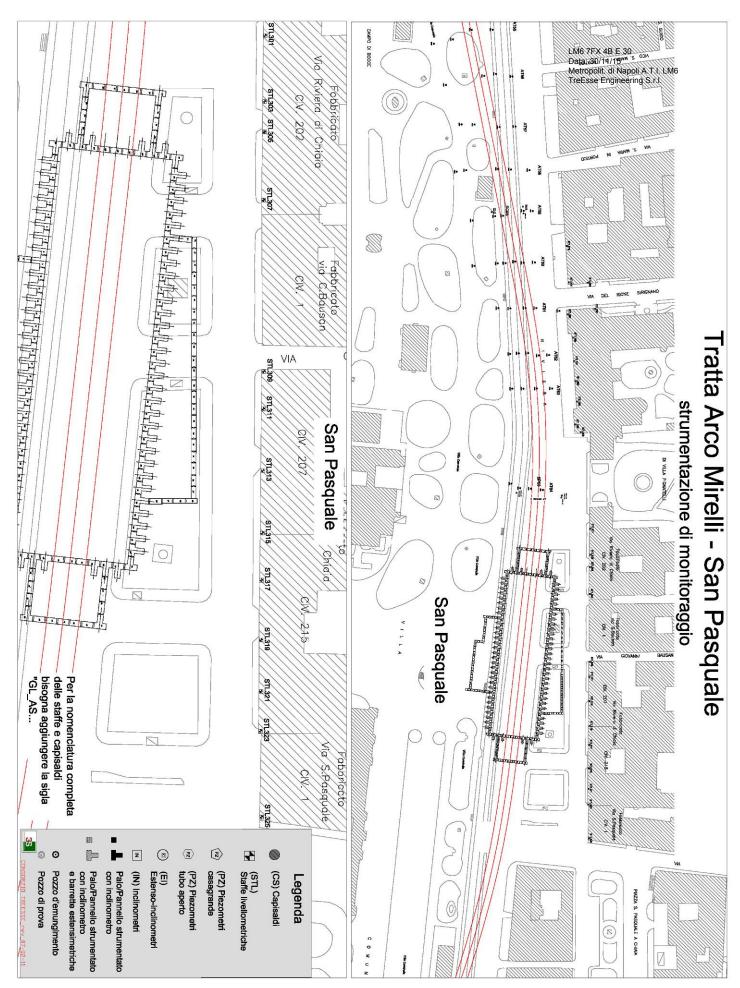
Planimetria tratta Arco Mirelli-SanPasquale, raffigurante la disposizione della terza installazione della strumentazione di monitoraggio.
